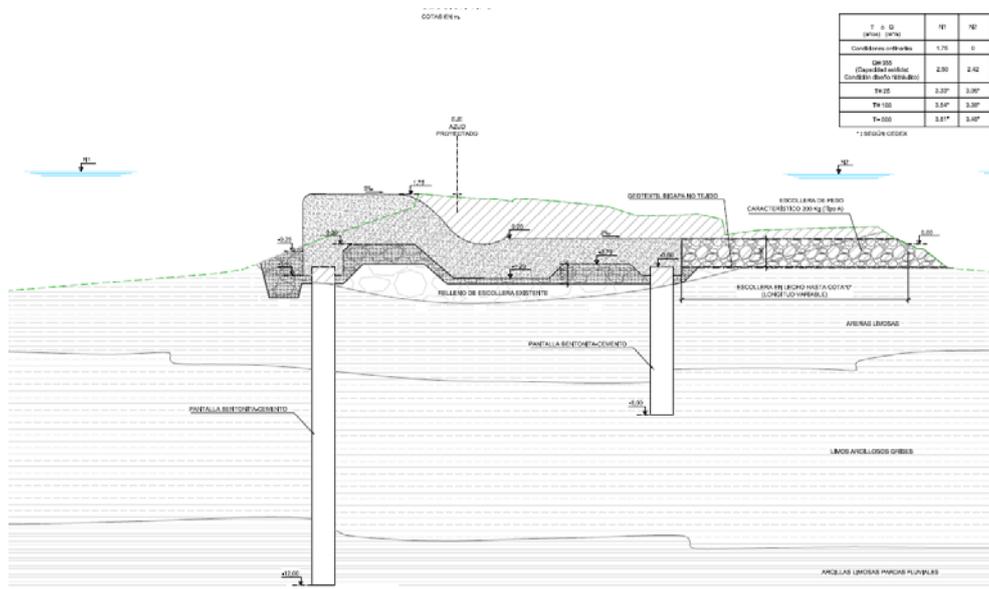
Sección tipo del azud propuesta en proyecto (CHJ, 2009)
